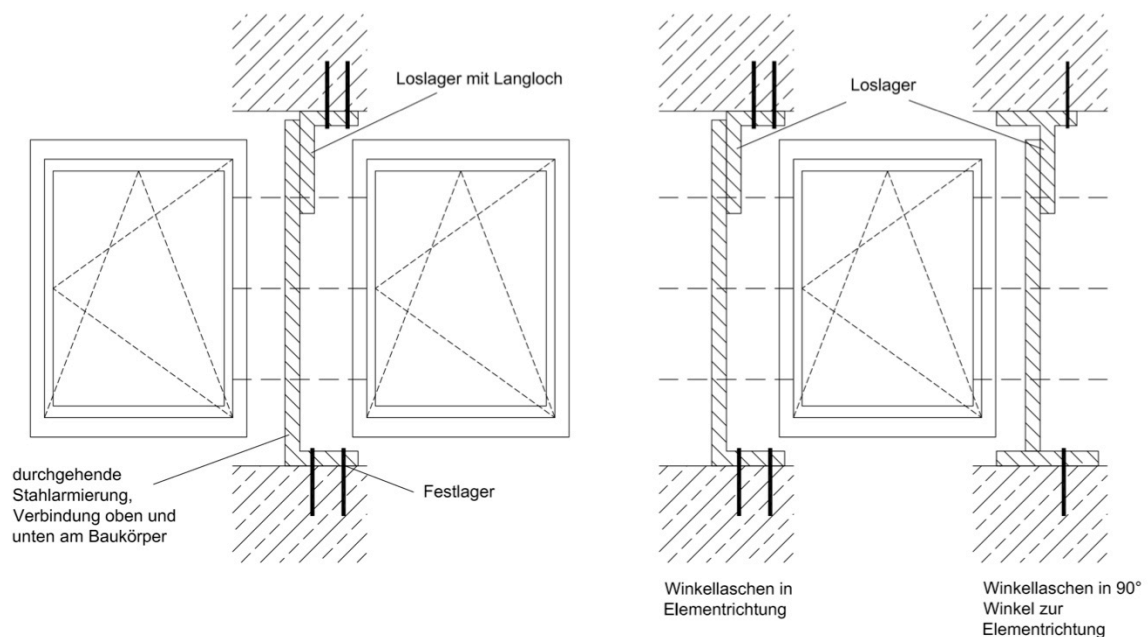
Darstellung von am Baukörper befestigten Armierungen mit Anschluss an Loslager
